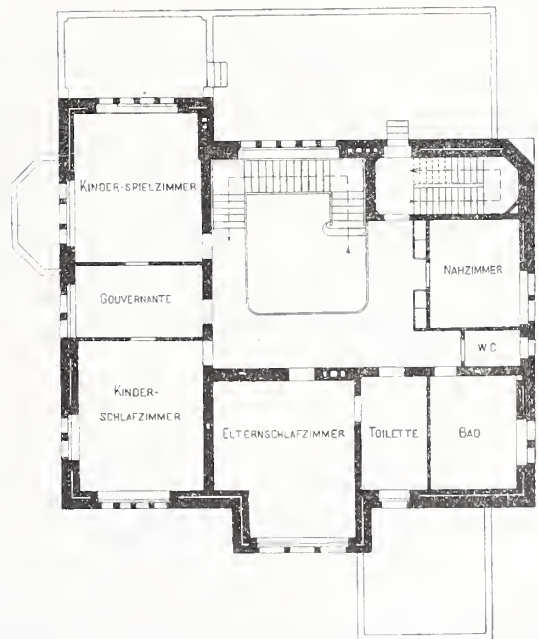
Grundriss vom I. Stock. — Masstab 1:300.
